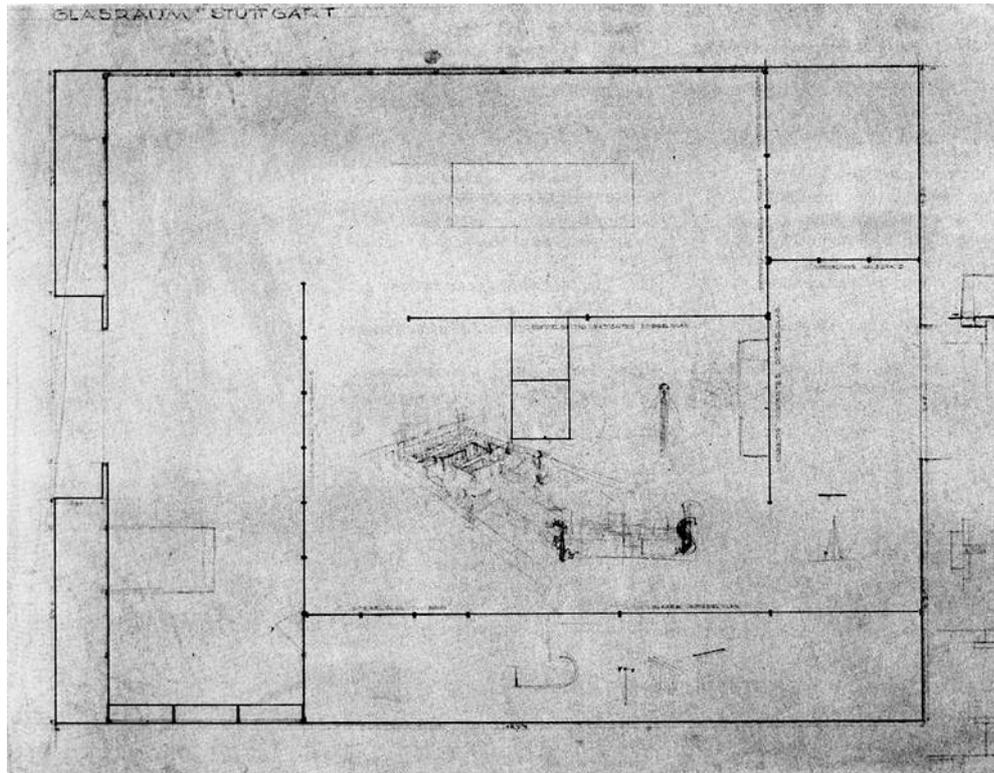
Imagen de la planta original de la Glasraum, pabellón perteneciente a la exposición de la vivienda de Stuttgart, Alemania, 1927.
